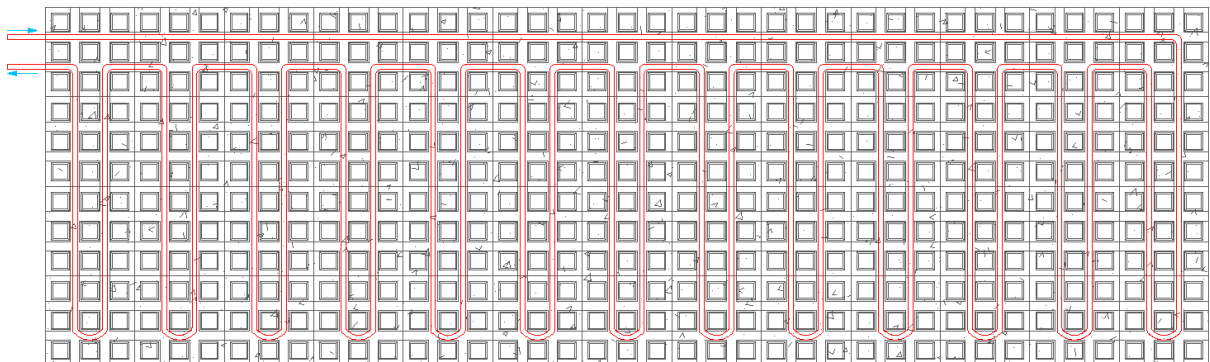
Passagem do tubo multicamada nos pré-fabricados
